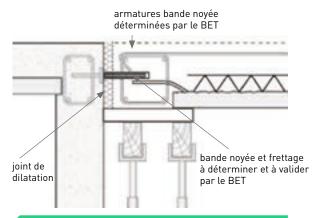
BANDE NOYÉE, FRETTAGE ET PRÉDALLE BA SANS SUSPENTE
